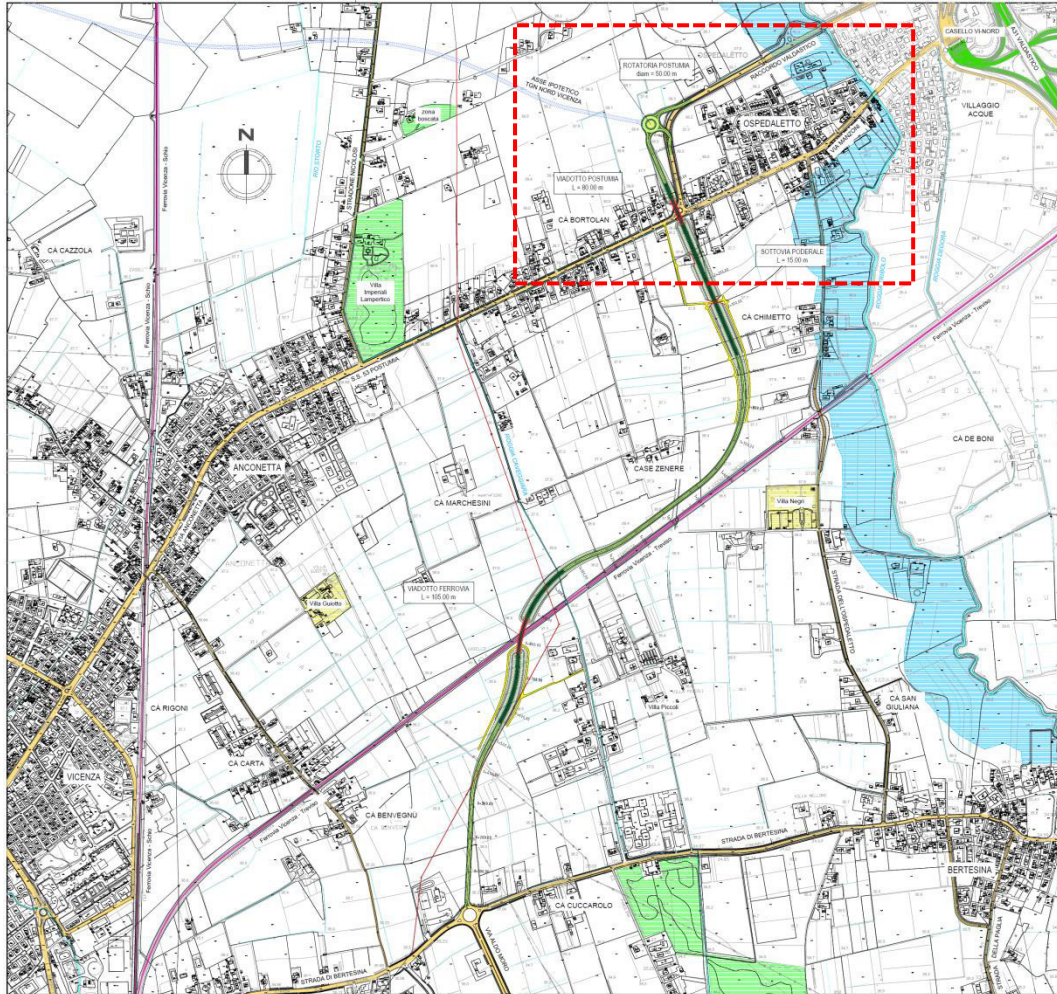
estratto della planimetria di Alternativa Ospedaletto A e zoom su scavalco SS 53
